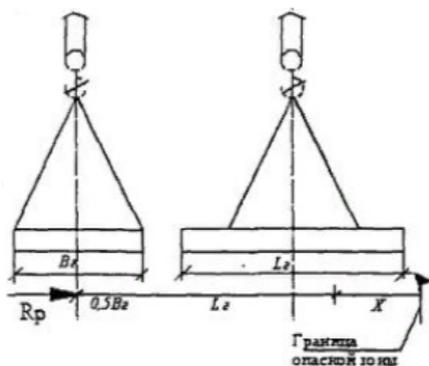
Определение границы опасной зоны при перемещении грузов кранами
